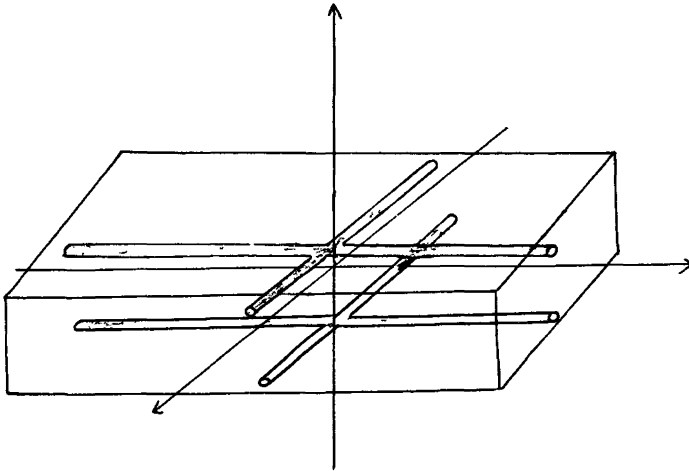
Cas de ferrailages soudés dans un même plan.
